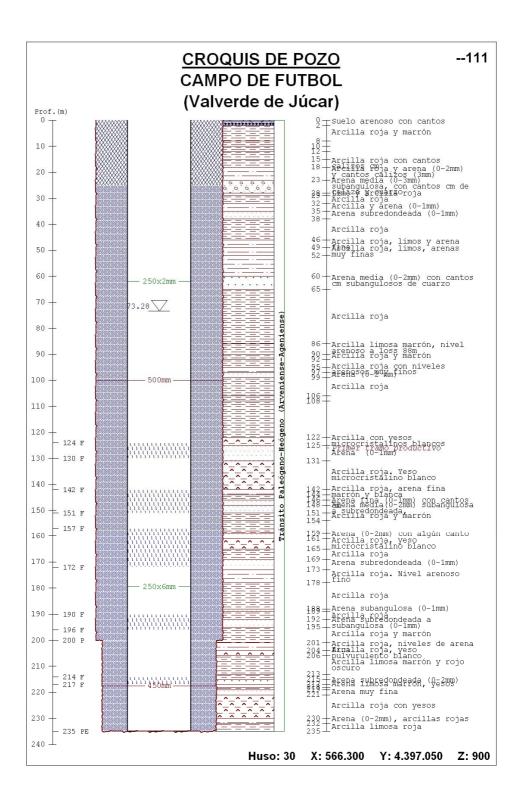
Perfil litológico y constructivo del sondeo Campo de Fútbol.
